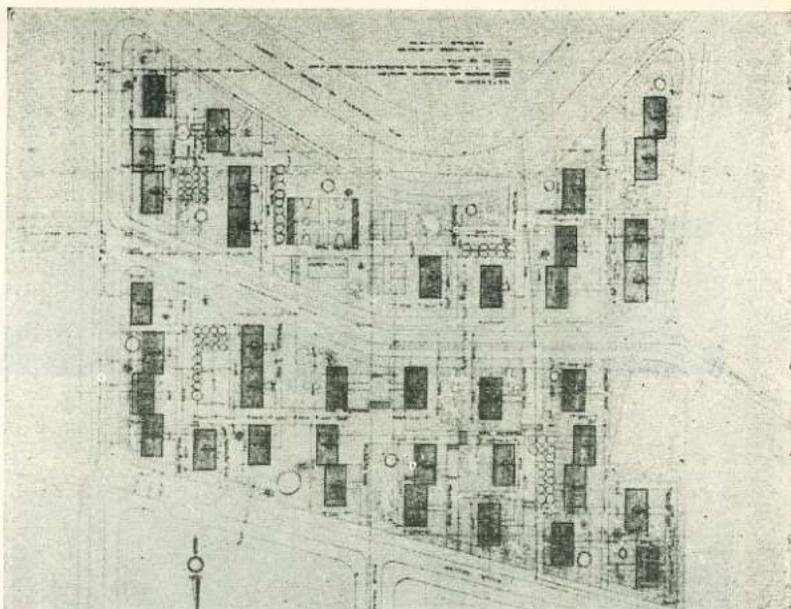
Unidad de Habitación "Barrio Sur" Planta tipo.
